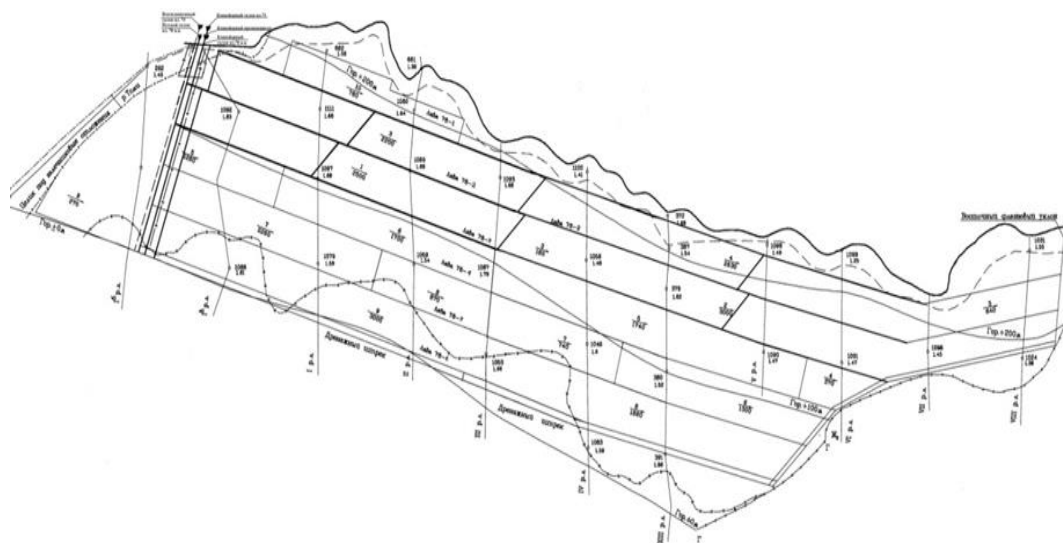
Схема размещения вскрывающих и подготовительных выработок пласта 78н.п. на участке Увальный Южный.
